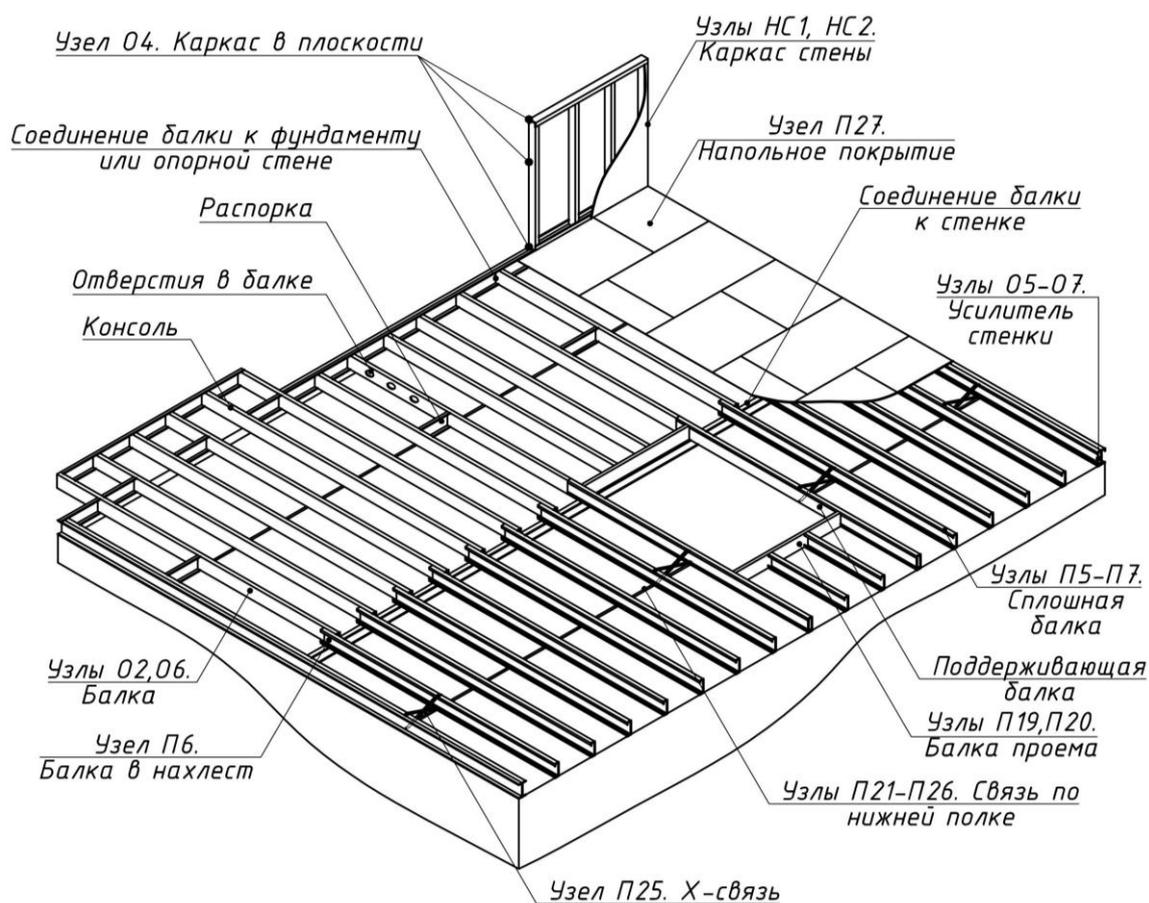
Узел П 1. Типовая схема каркаса перекрытия
